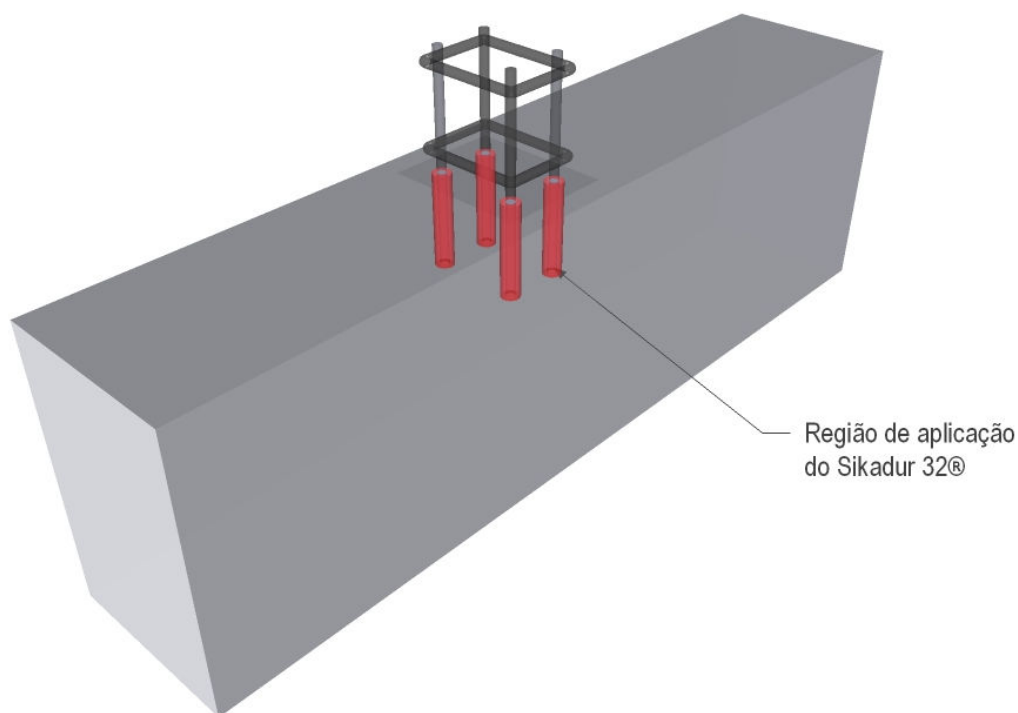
Barras de aço coladas com adesivo estrutural Sikadur 32®
